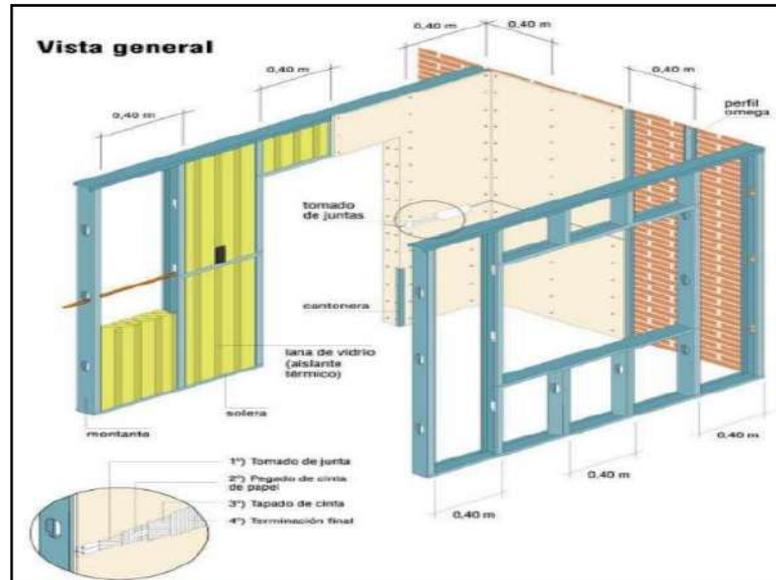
Estructura para drywall. FUENTE: Elaboración Propia
